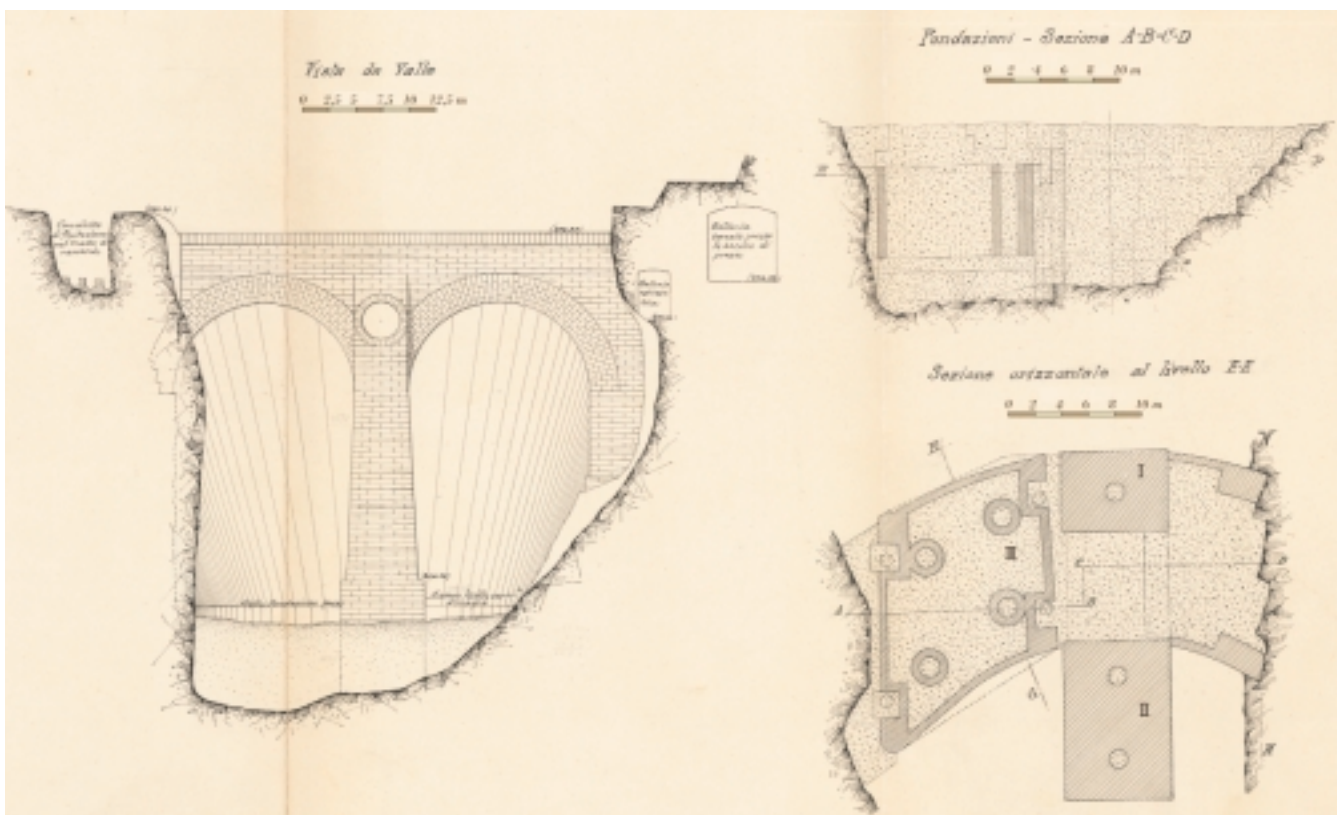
Diga di Ponte della Serra, prospetto da valle e sezioni.
